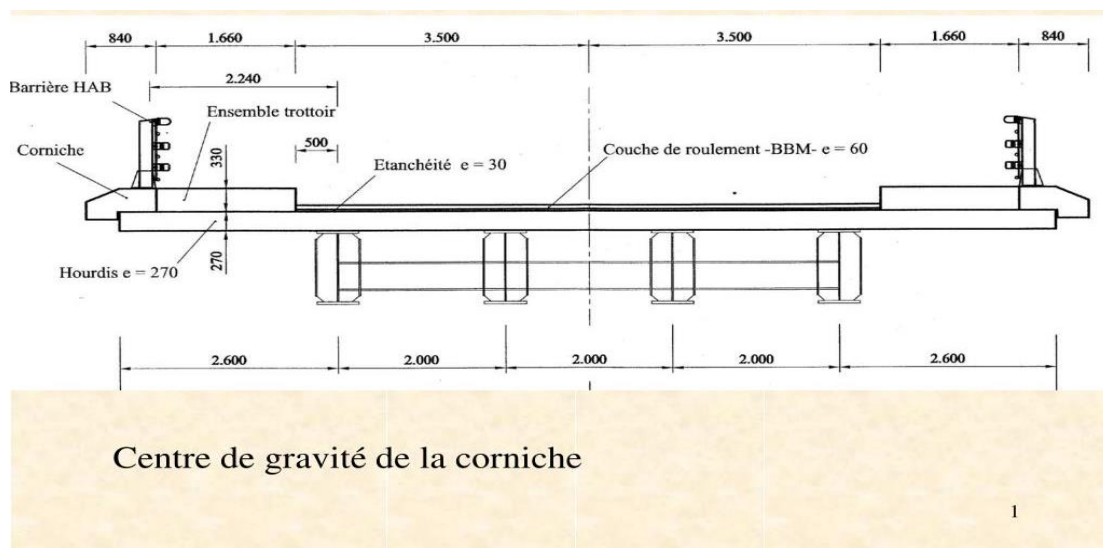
Coupe transversale d'un pont à poutres multiples.
